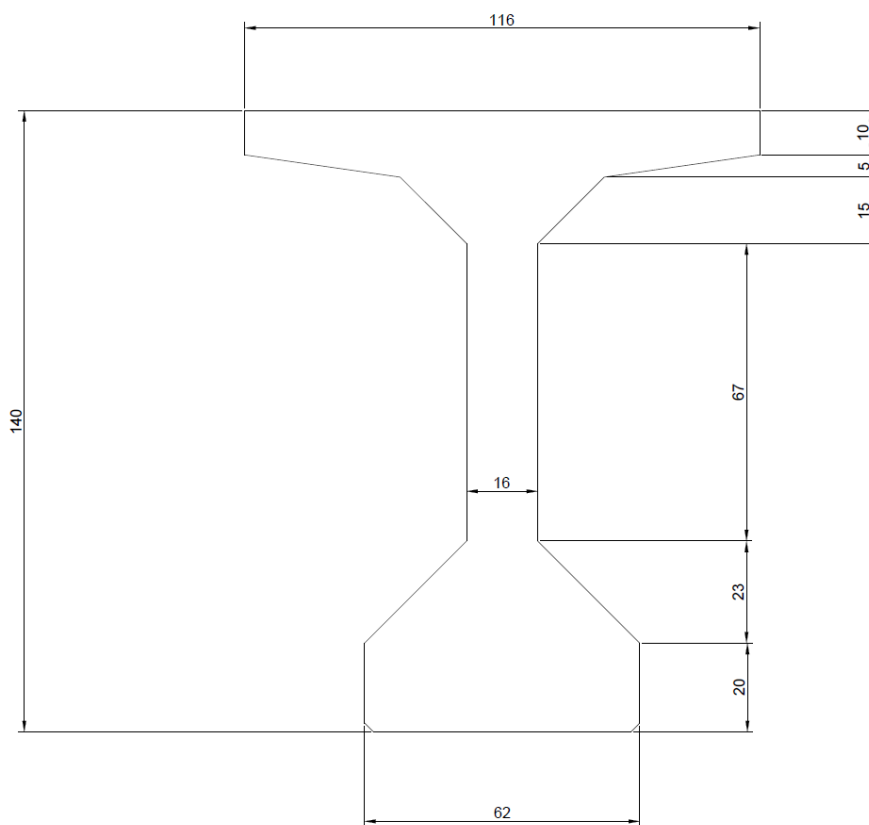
Corte de Viga de Postensado Puente Águila Norte.
